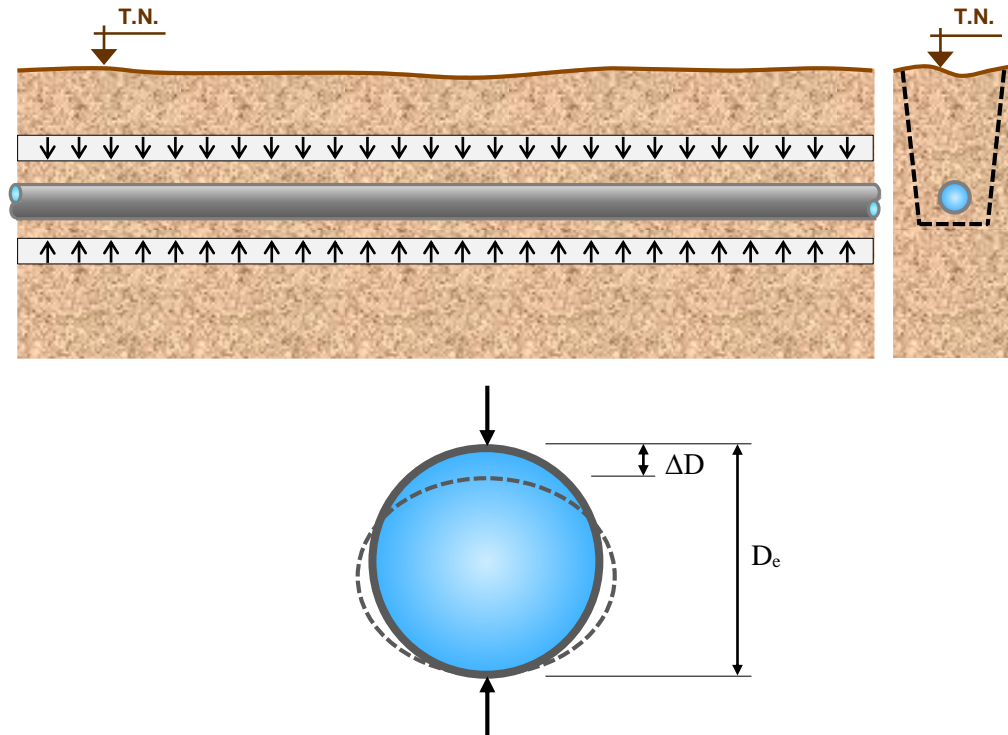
Tubería soterrada sometida al aplastamiento de la sección.
